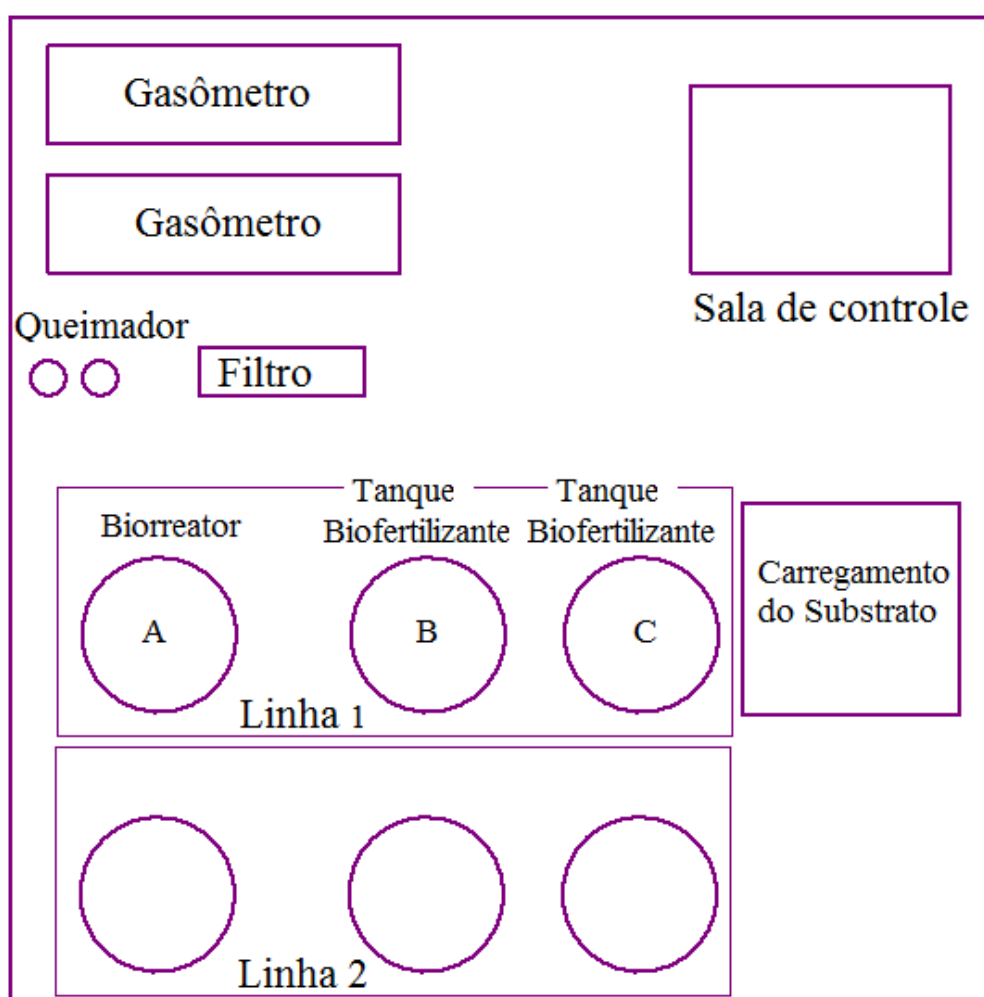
Planta baixa com a disposição dos tanques, gasômetros filtro e queimador.
